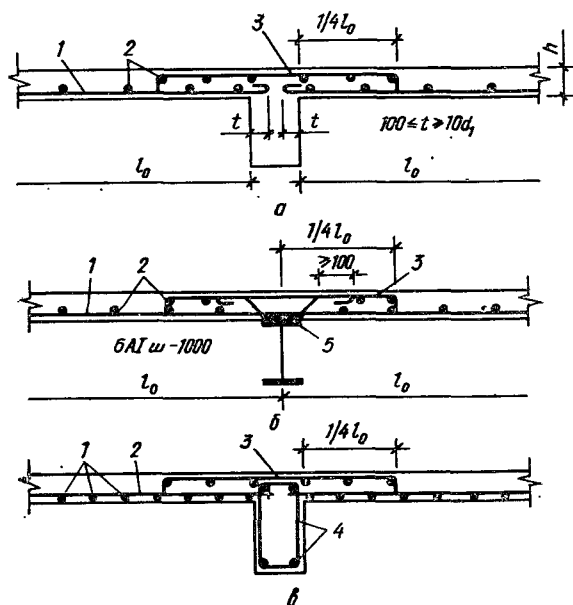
Армирование средних опор монолитной плиты отдельными стержнями:
